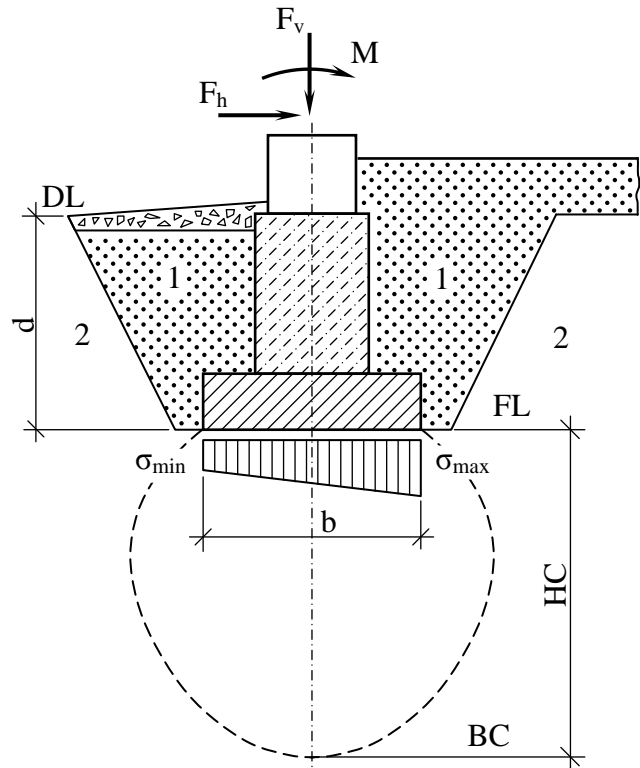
Схема взаємодії фундаменту, який споруджується у відкритому котловані, з навколишнім ґрунтом:
